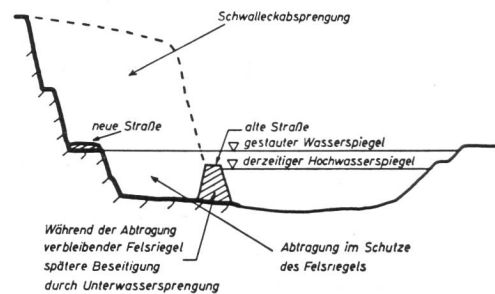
Bauvorgang für die Absperrung des Schwallecks
